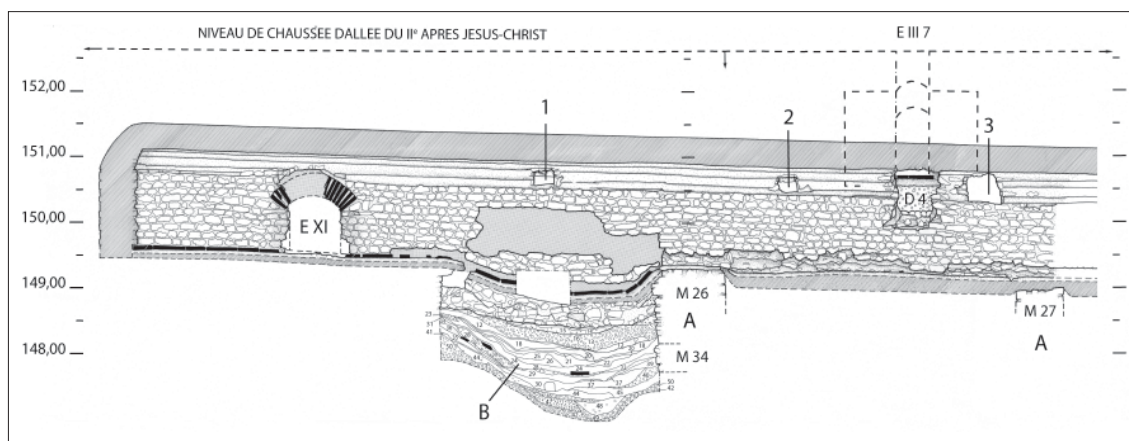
Elévation de la paroi nord du collecteur E VIII au niveau de la place Triangulaire et de la rue des Thermes. 1 à 3 : débouchés intégrés d'origine à la maçonnerie ; A : façades de la voie III antérieures aux thermes ; B : comblement du fossé originel de la voie III. (L. Brissaud).
